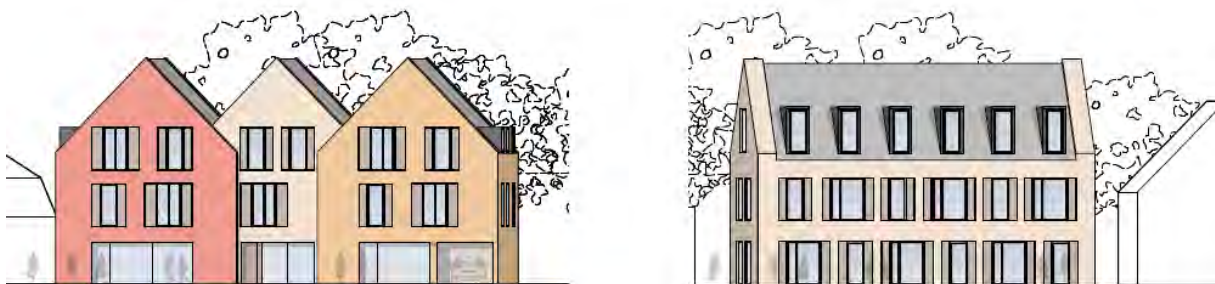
Straßenansichten des geplanten Neubaus Hauptstraße 31; Hauptstraße (links), Alte Straße (rechts)
